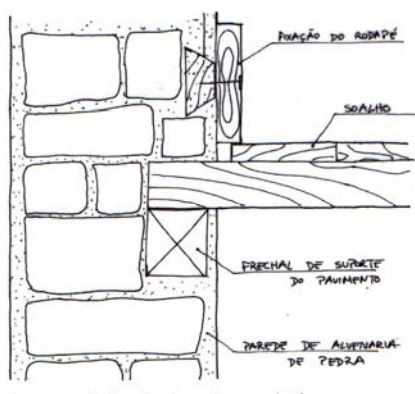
Ligações das vigas à alvenaria de pedra, retirado de [Lamas, 2003]
